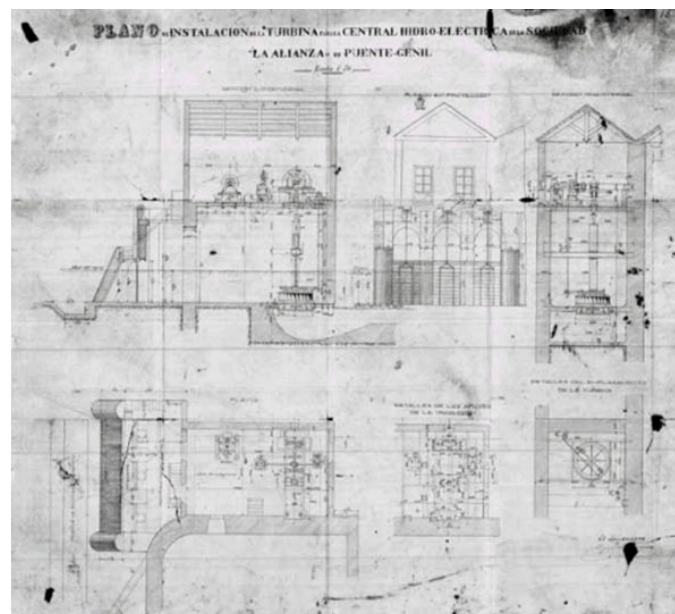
Plano de instalación de la central hidroeléctrica. Fuente: Archivo La Alianza. Ayuntamiento de Puente Genil.
